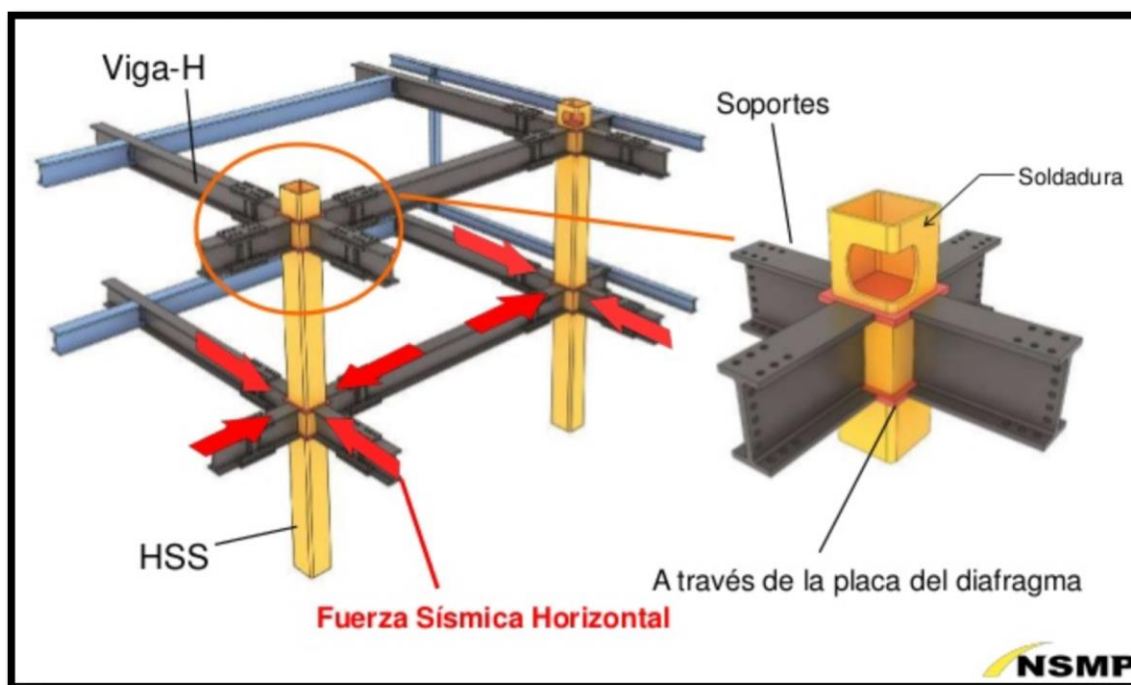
Sistema Column-tree con conexión soldada de placa diafragma de columna HSS a Viga W. (Ruiz, 2013)
